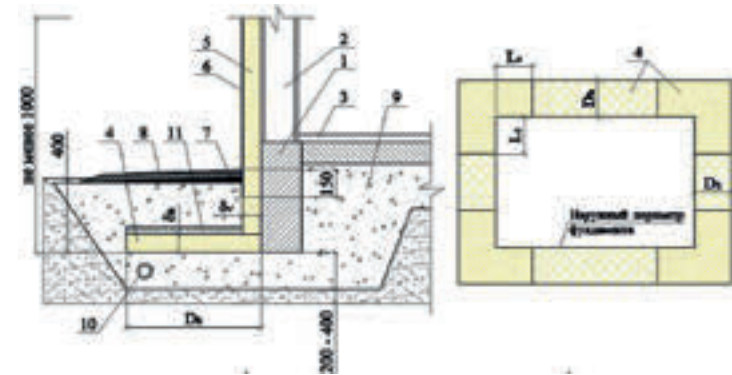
Схема укладки и параметры теплоизоляции в фундаментах отапливаемых зданий без теплоизоляции пола для, общественных и производственных зданий
